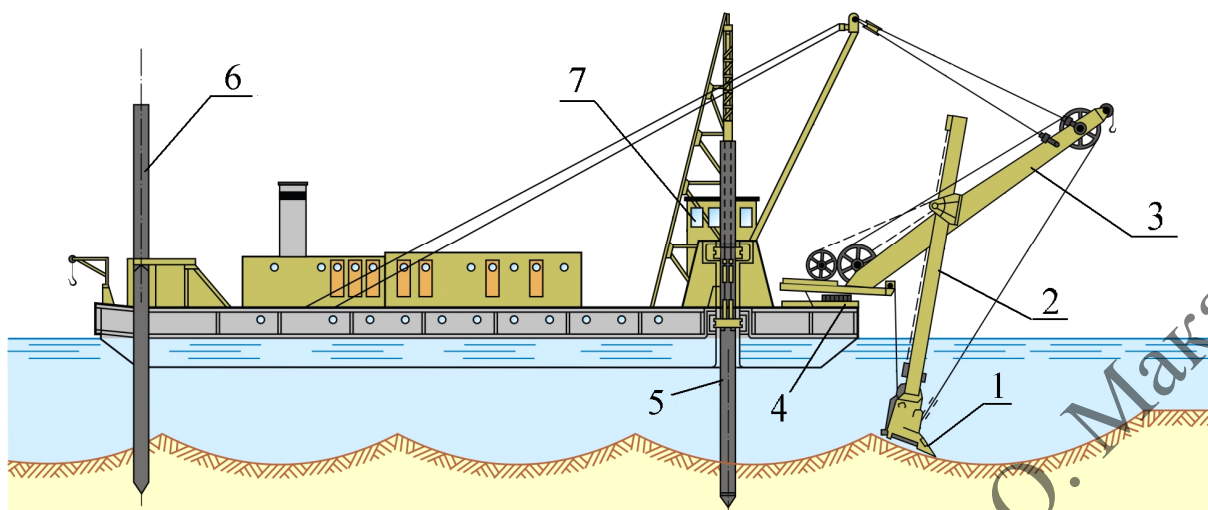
Штанговый земснаряд: 1 — ковш; 2 — штанга; 3 — стрела;
